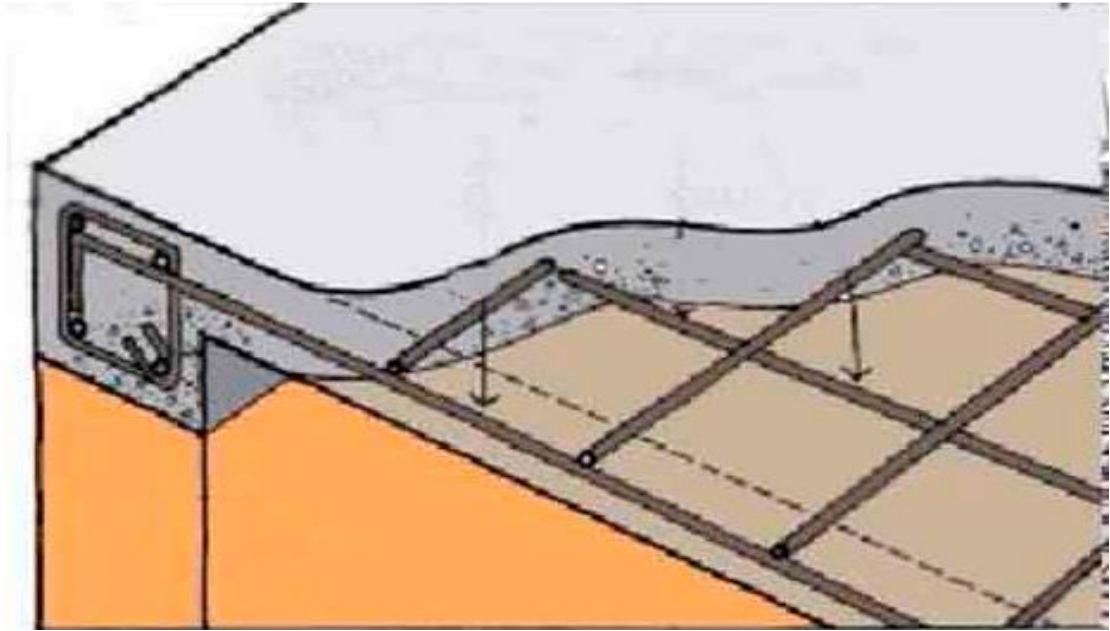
74 Losa maciza reforzada en dos direcciones.
